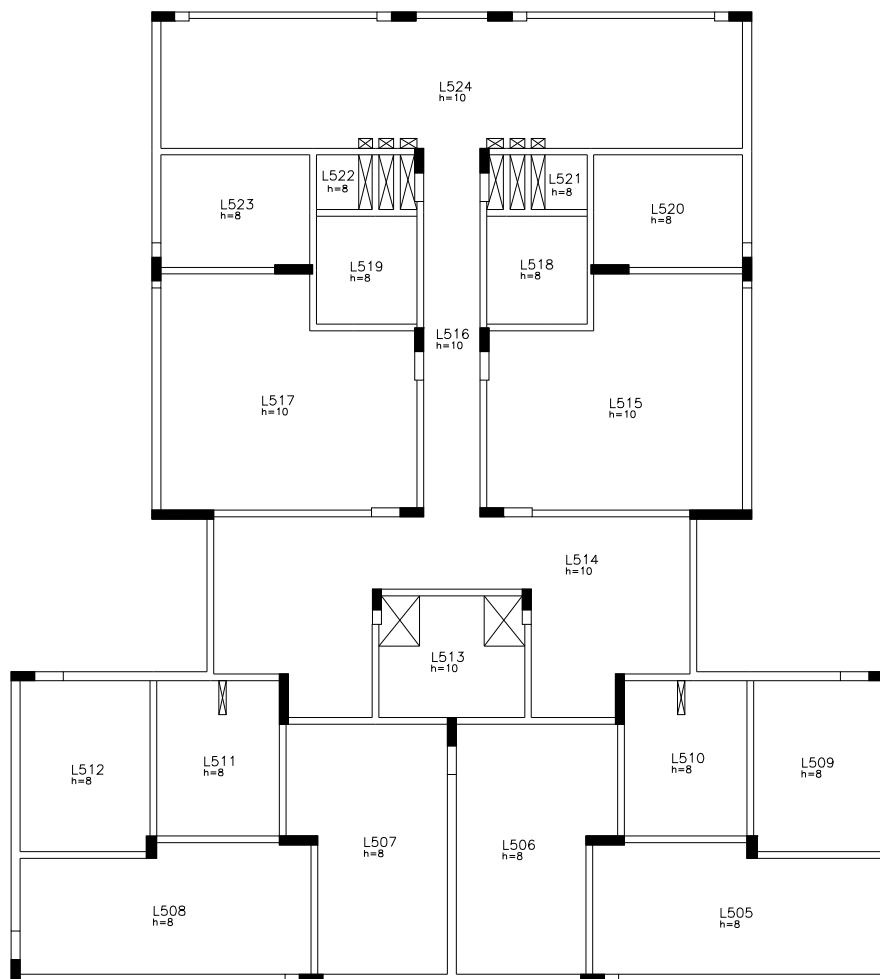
geometria dos elementos estruturais de um setor do pavimento tipo
